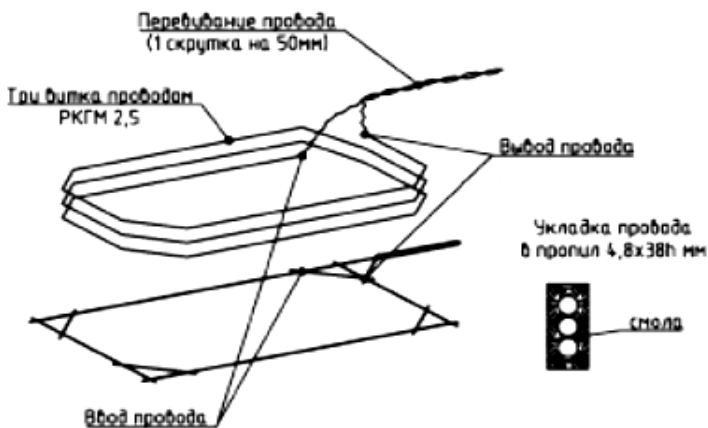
Схема укладки провода в пропилы в покрытии для формирования индуктивной рамки
